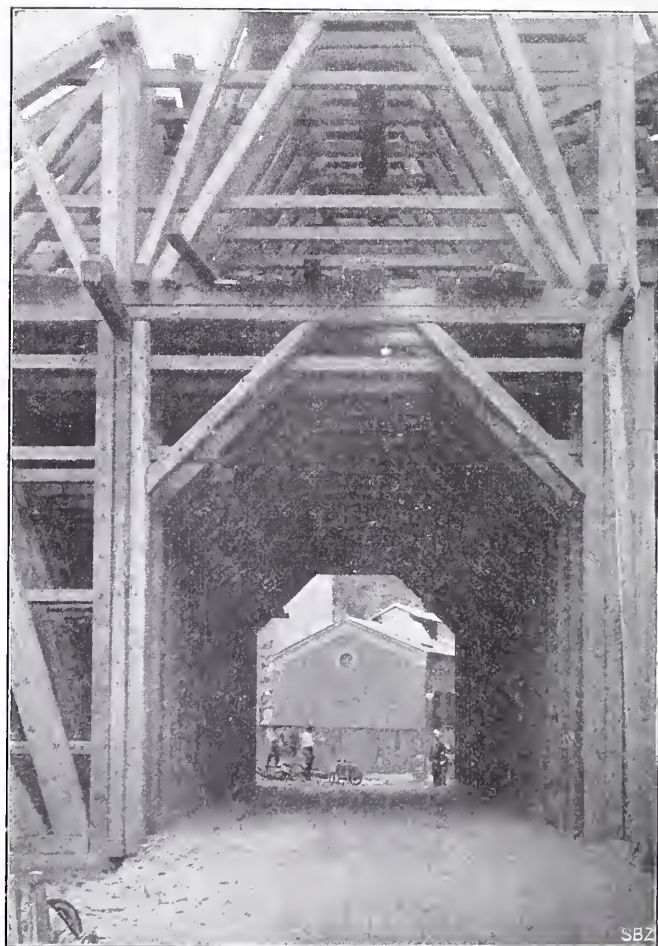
Durchfahrt unter dem Lehrgerüste.
